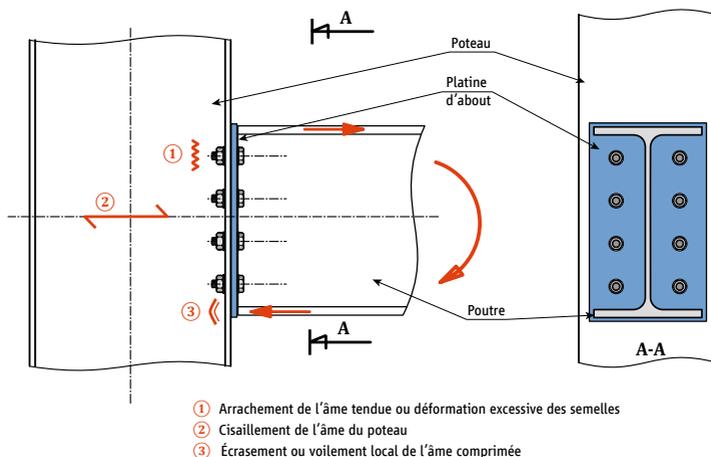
Encastrement d'une traverse sur un poteau en I ou en H par platine d'about
